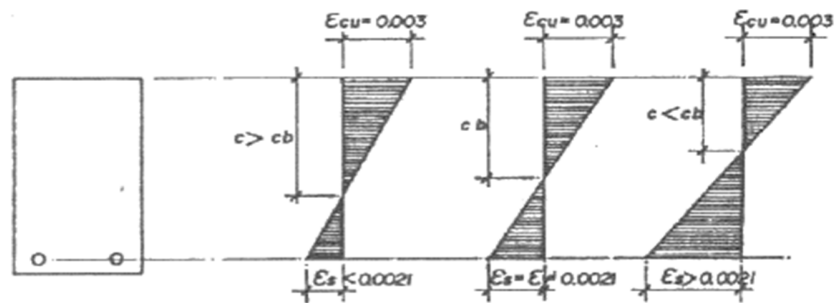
Viga Sobre-reforzada / Viga Balanceada / Viga Sub-reforzada
